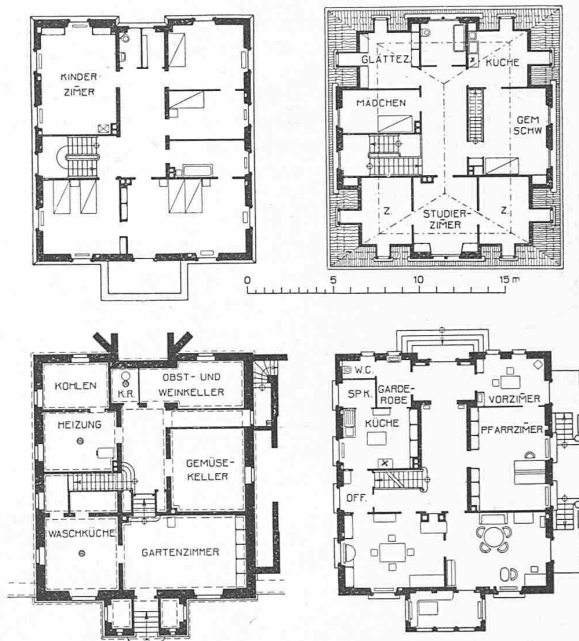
bis 10. Pfarrhaus-Grundrisse. — 1:400.
